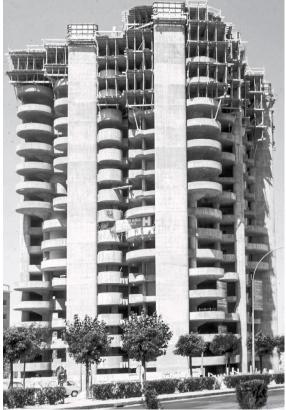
Edificio 'Torres Blancas': armadura superior de la planta tipo. El edificio en construcción. Sáenz de Oíza, 1958-68. (*Informes de la Construcción*, 23 (226): 43-64).
